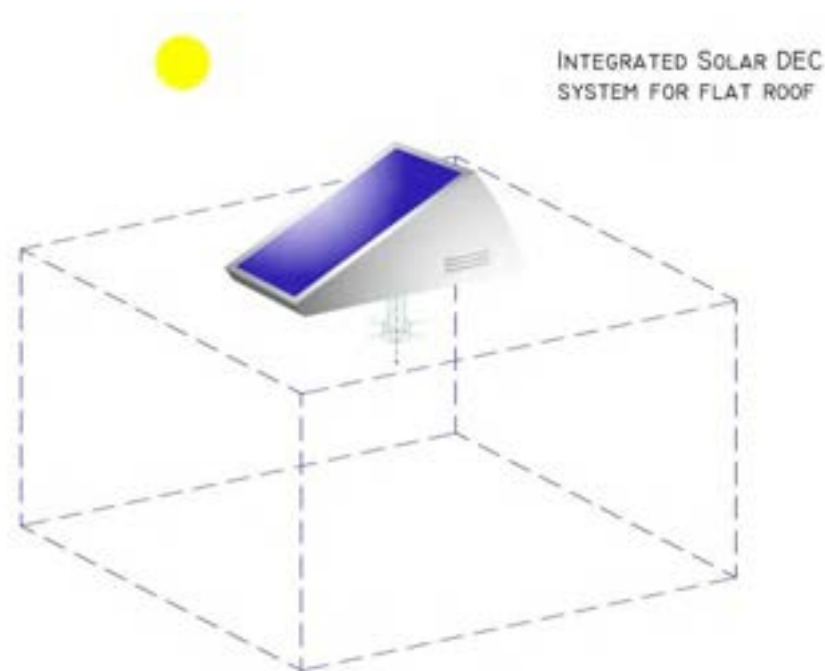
Schema di posizionamento dell'unità rispetto al locale da servire
